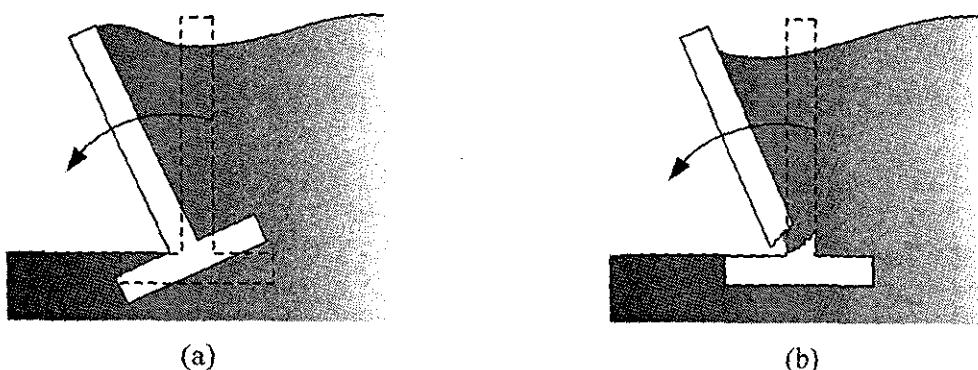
ลักษณะทั่วไปของกำแพงกันดินชนิด Cantilever wall
